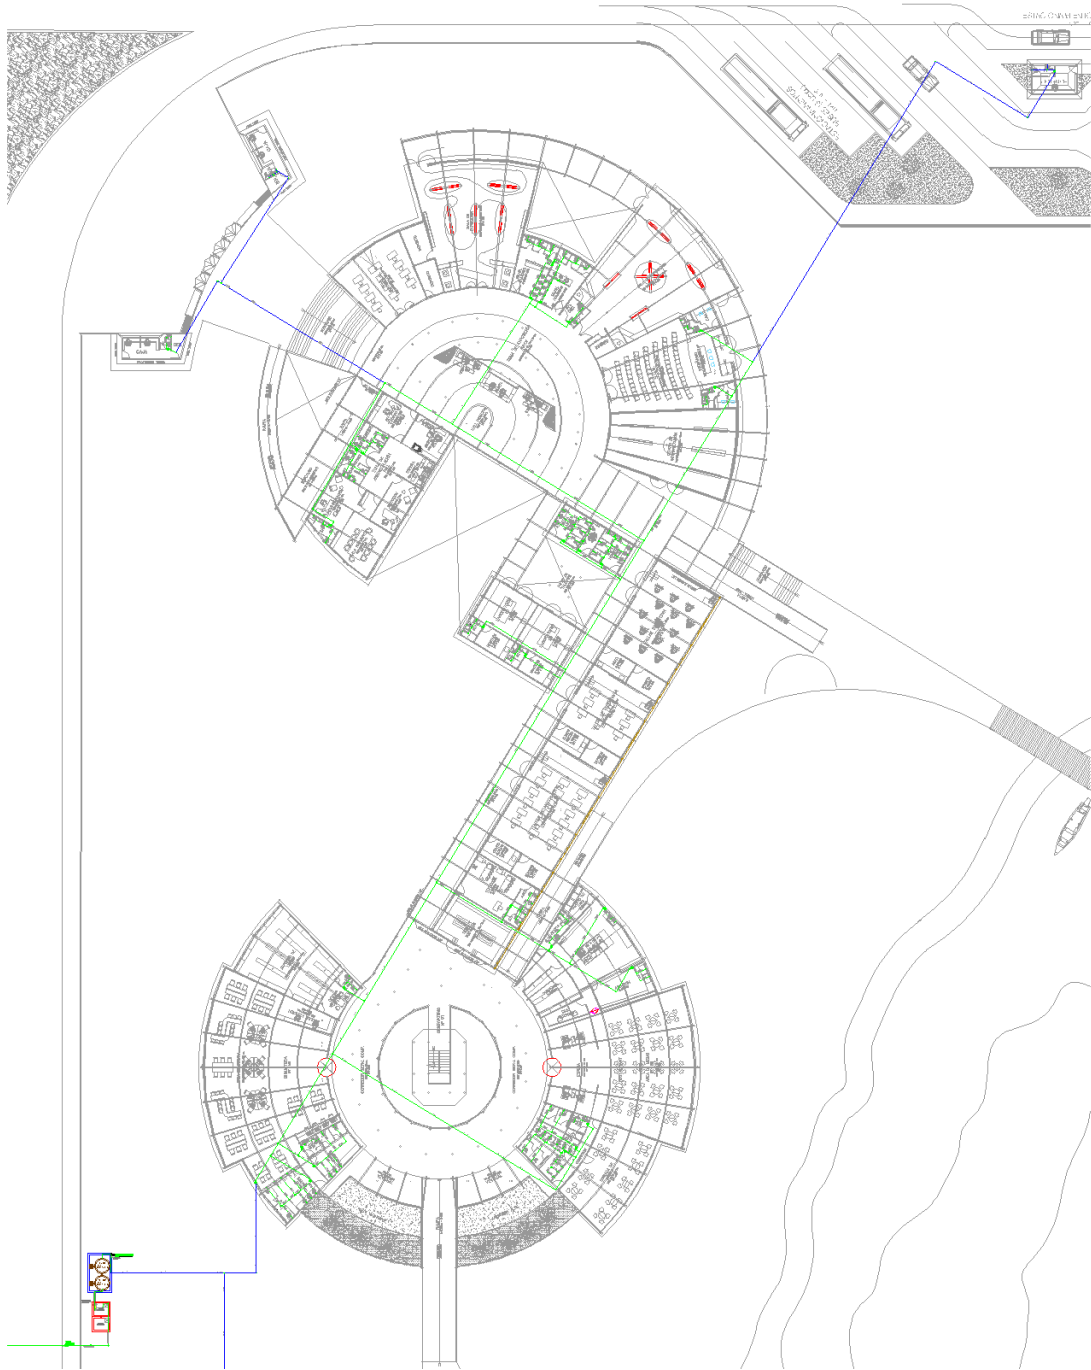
Plano de instalaciones sanitarias-agua primer bloque
